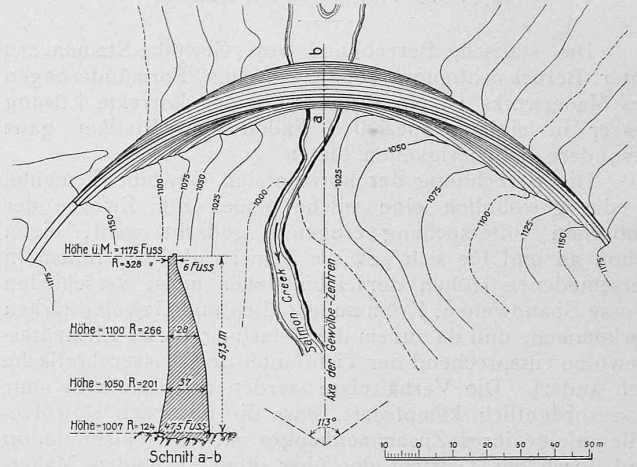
Grundriss und Querschnitt der Salmon-Creek-Staumauer. — 1:2000.
